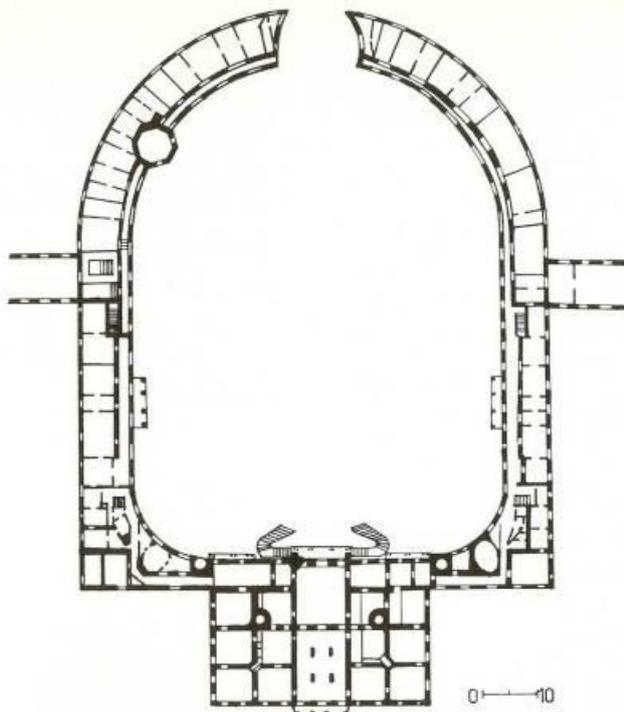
Schloss Esterházy, Grundriss (EG)
